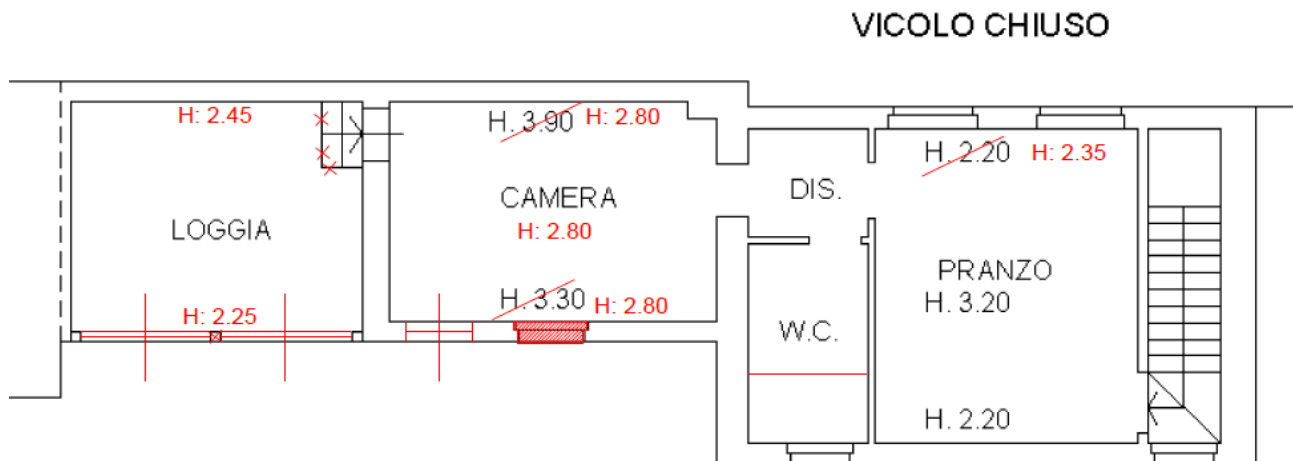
planimetria di raffronto con difformità riscontrate da rilievo in data 18/10/2022
